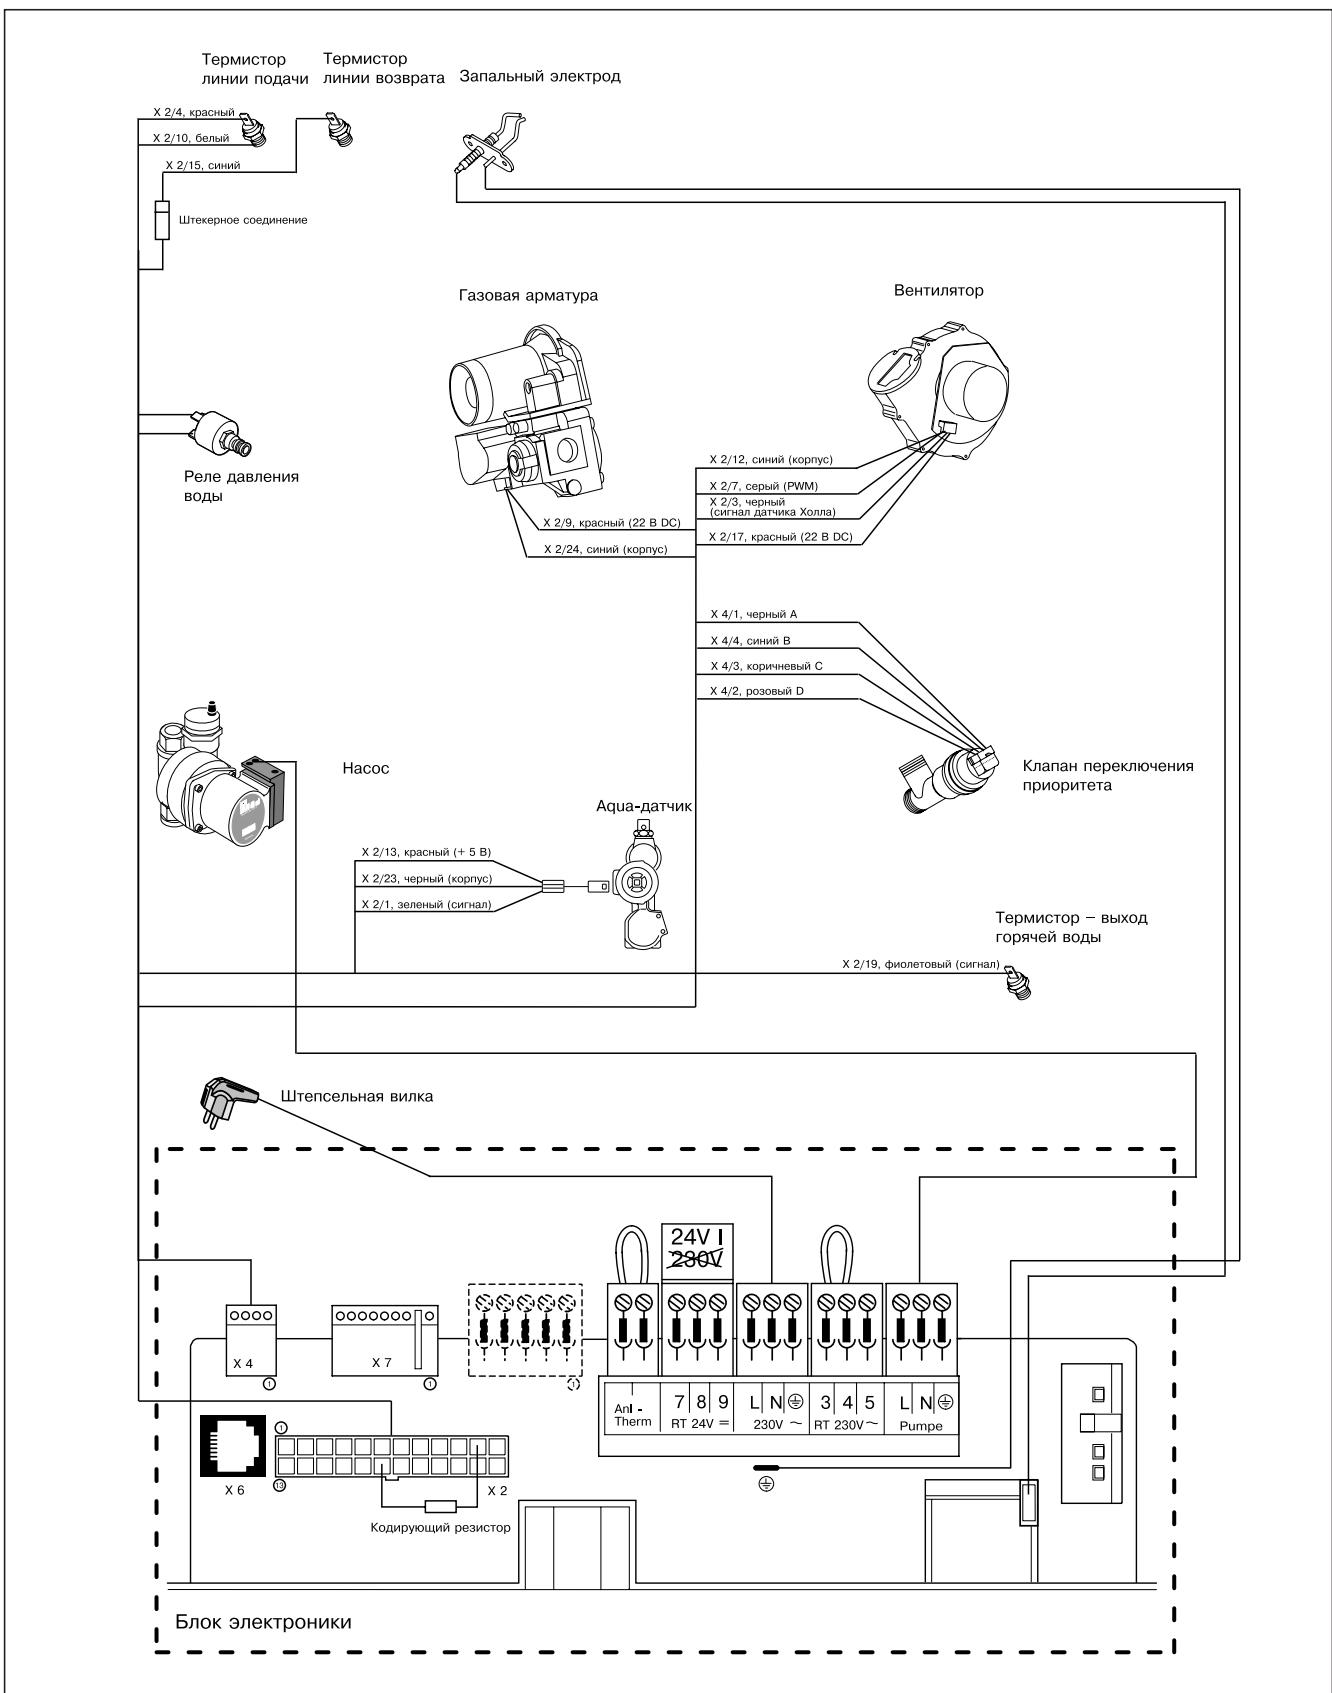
Схема проводного монтажа ecoTEC VUW
